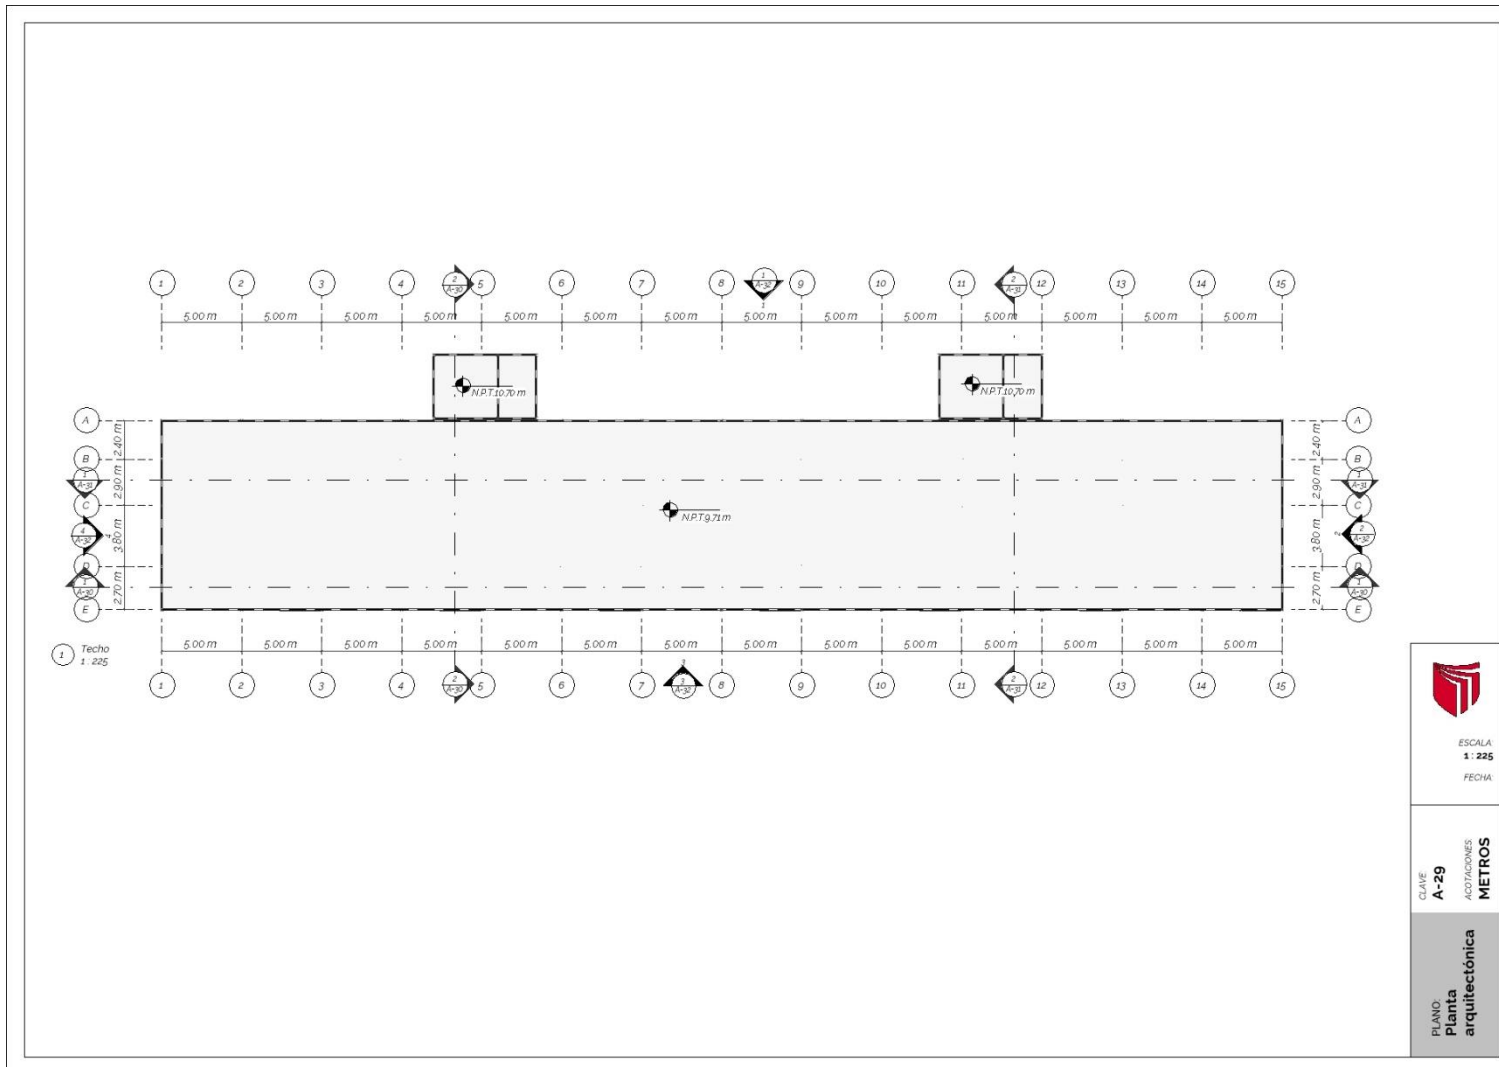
Planta arquitectónica hotel hab. Suites (planta de techo)
